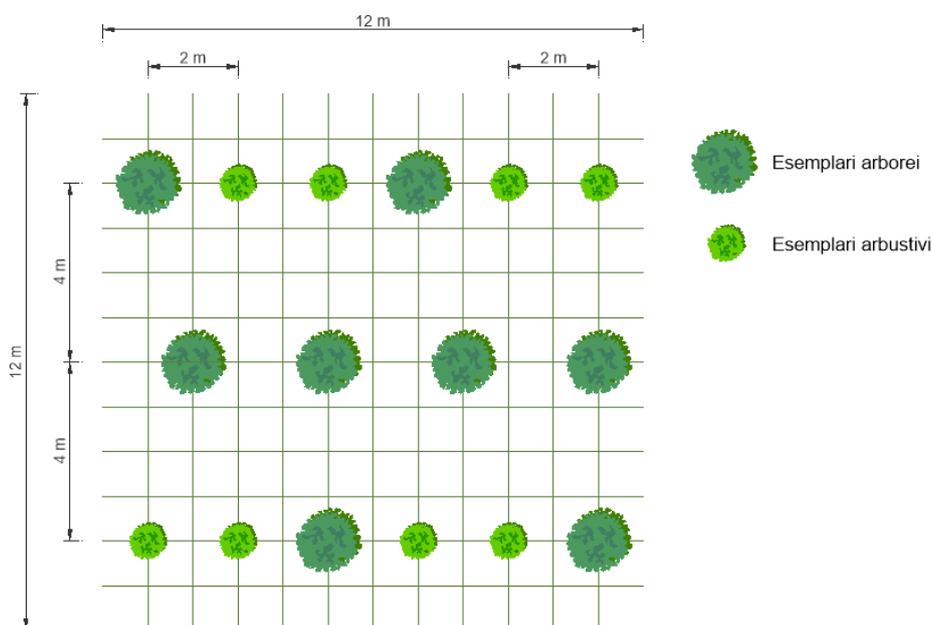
Schema d'impianto delle fasce boscate in progetto.
